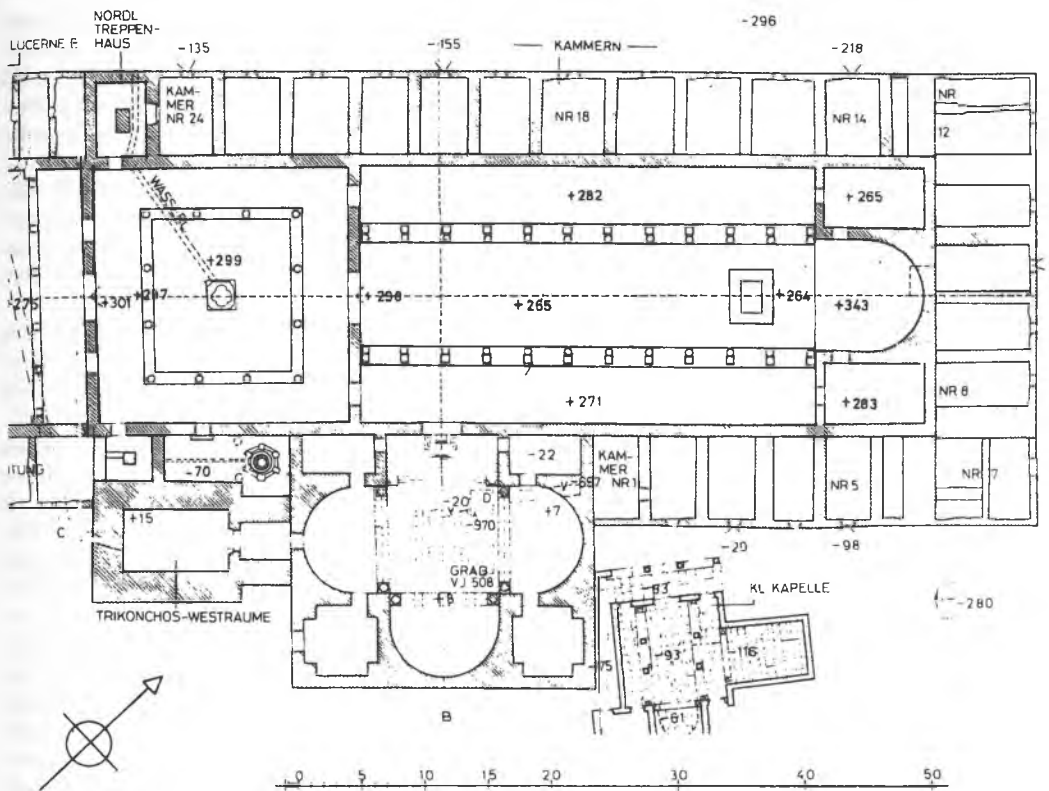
Tebessa, Basilika u. Trikonchos, Grundriss mit Angabe des Schnittes Abb. 10. Nach Christern, Pilgerheiligtum Fig. 1.
